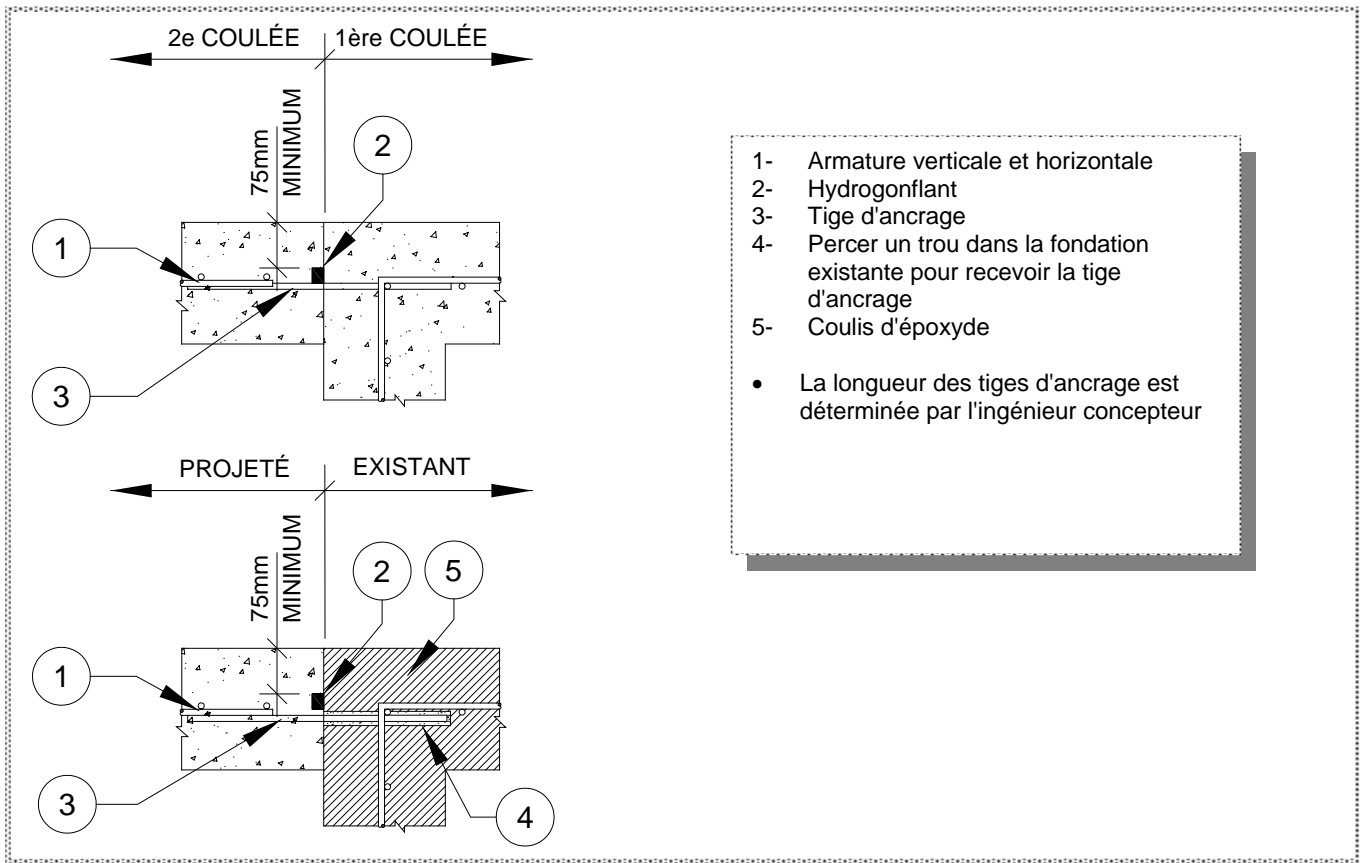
Étanchéité entre les murs d'une plate-forme et un puirot lors d'un même chantier ou pour l'agrandissement d'un lieu d'entreposage (Joint en construction)
